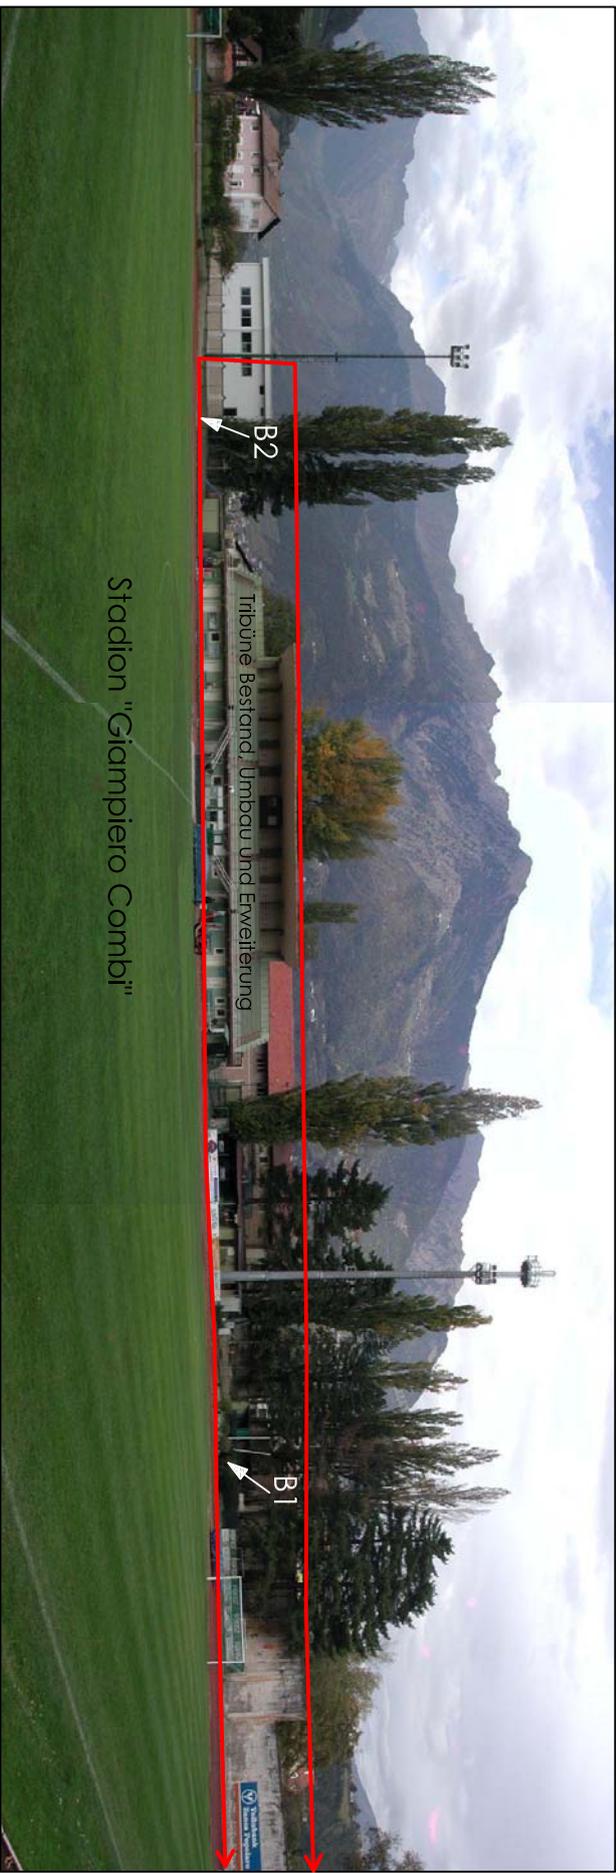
Übersichtsfoto des (—)geplanten Bauareals mit Blick Richtung Nordwesten
